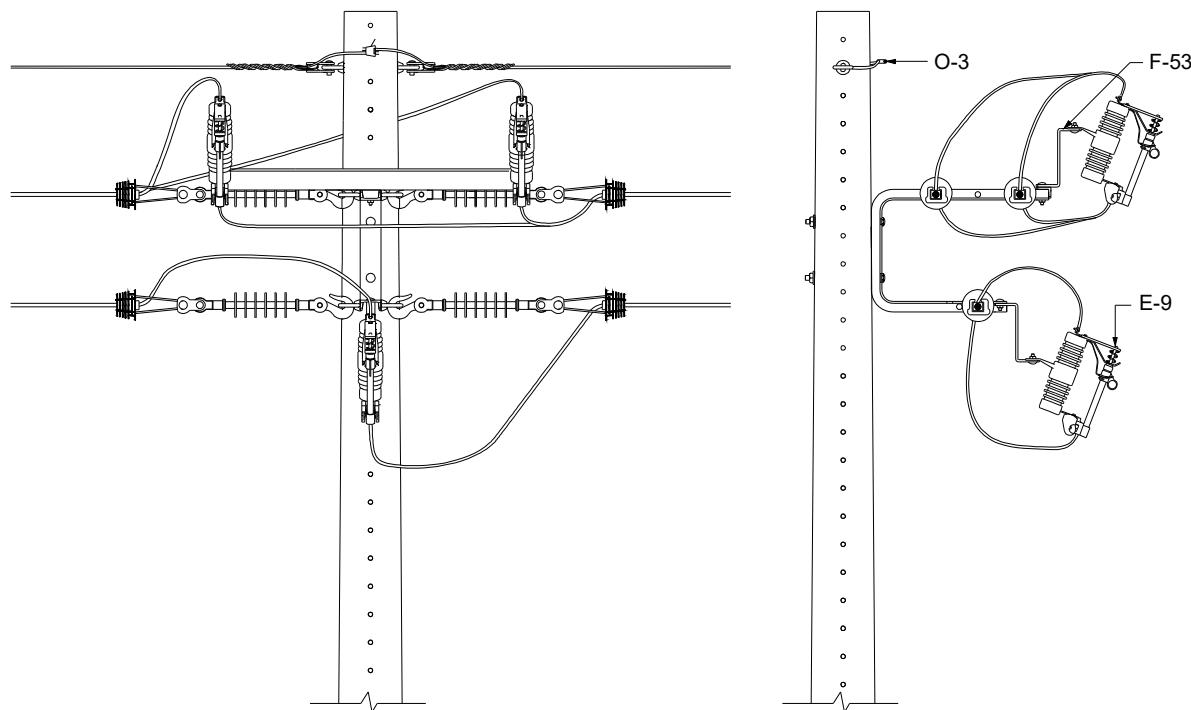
Instalação de equipamento – Chave fusível – Seccionamento - Estrutura trifásica – Estrutura C4
